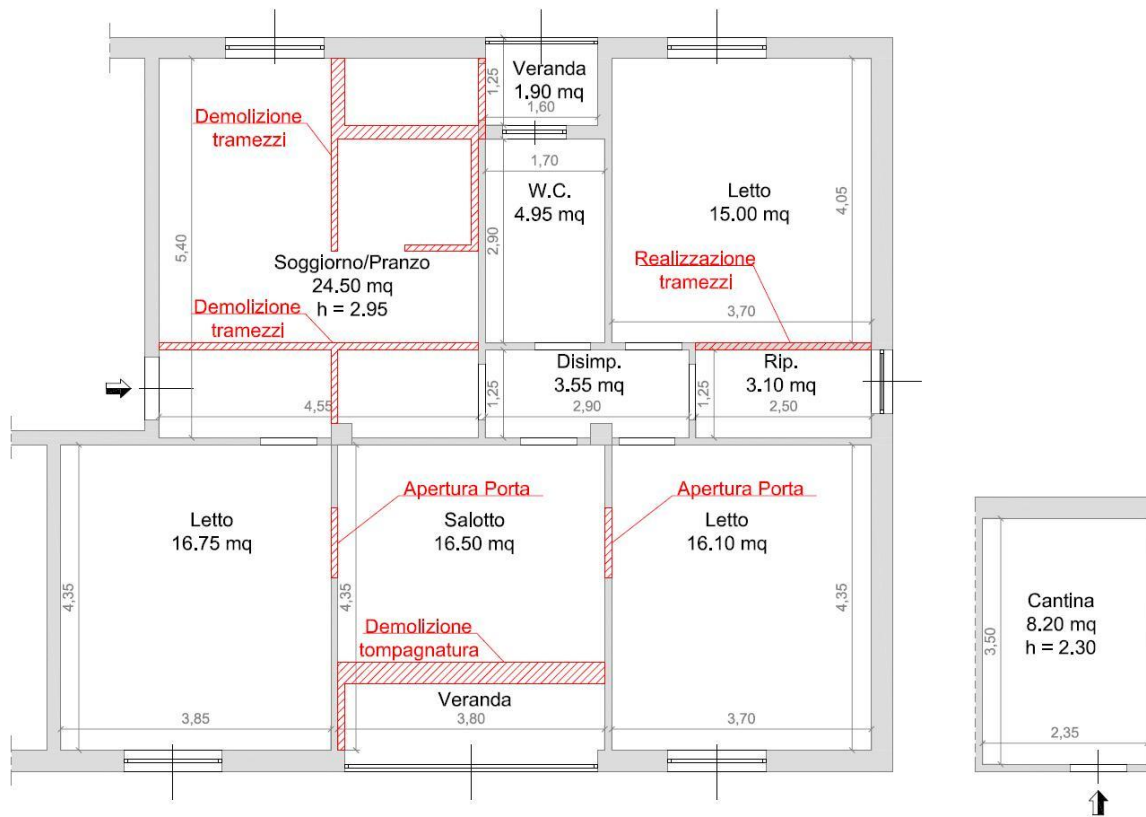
Planimetria Stato di fatto Foglio 29, p.lla 748, sub 45.
